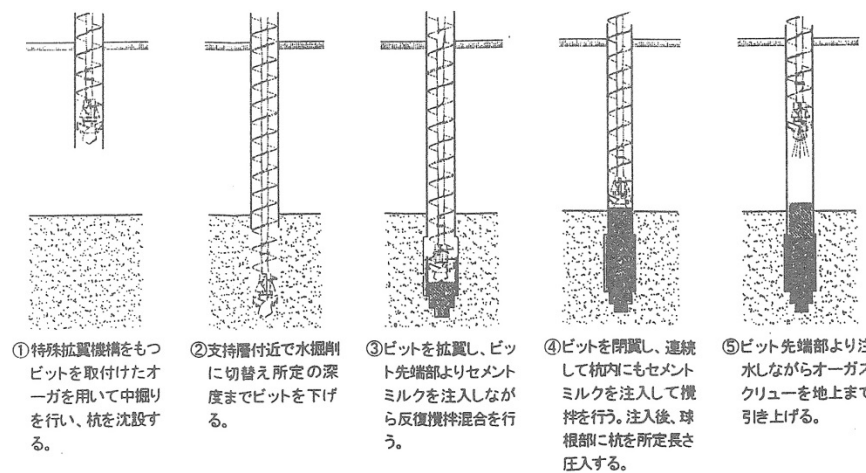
(a) T B S 工法 (R P タイプ) の施工手順
